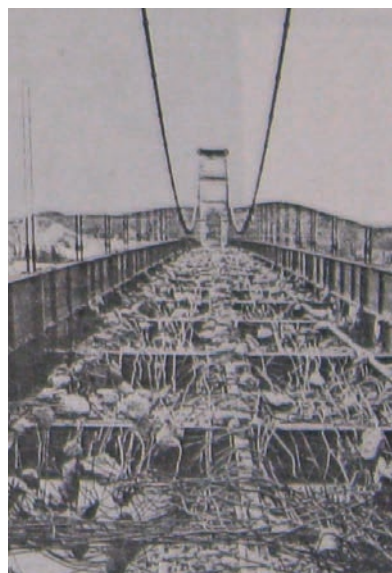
Démolition de la dalle béton au brise roche (allègement du pont et amoindrissement de sa résistance)
